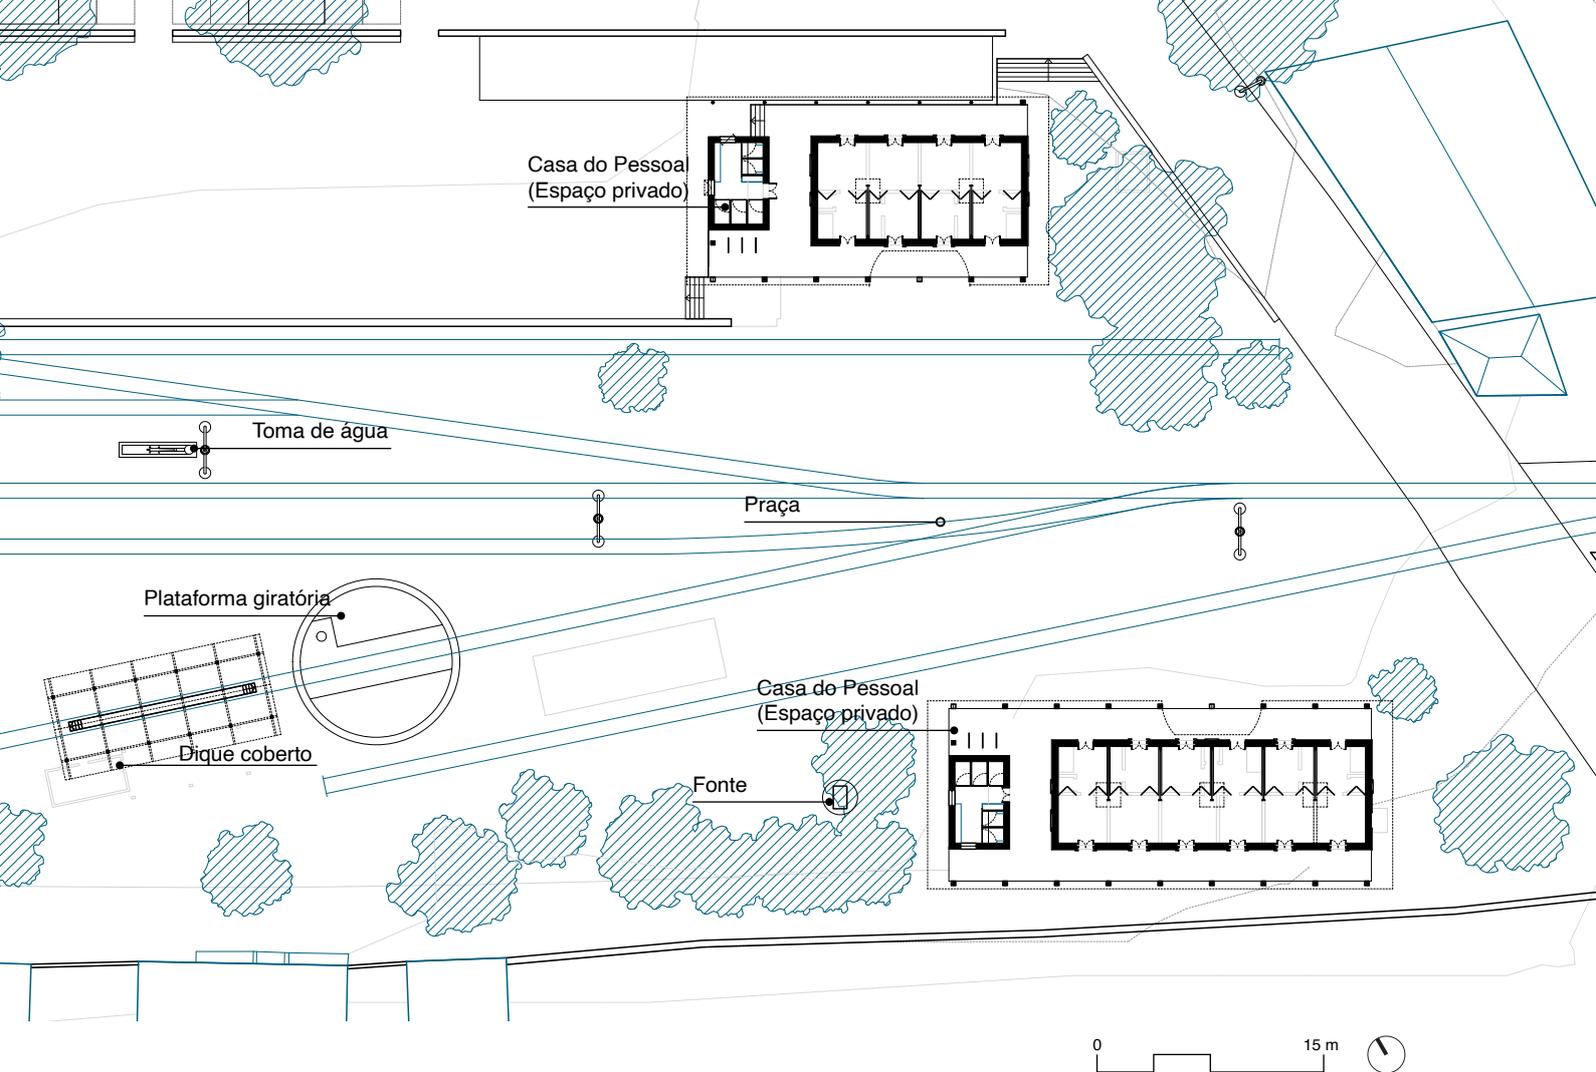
Planta da proposta da estação de Duas Igrejas-Miranda
